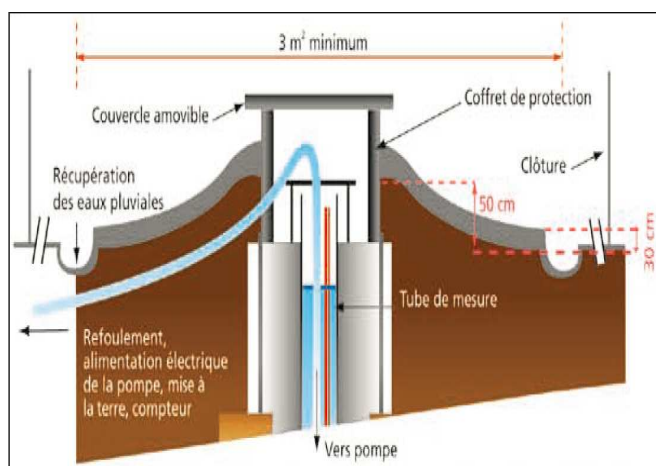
Dispositions techniques pour la création d'un forage d'eau (Plaquette éditée par le BRGM)
